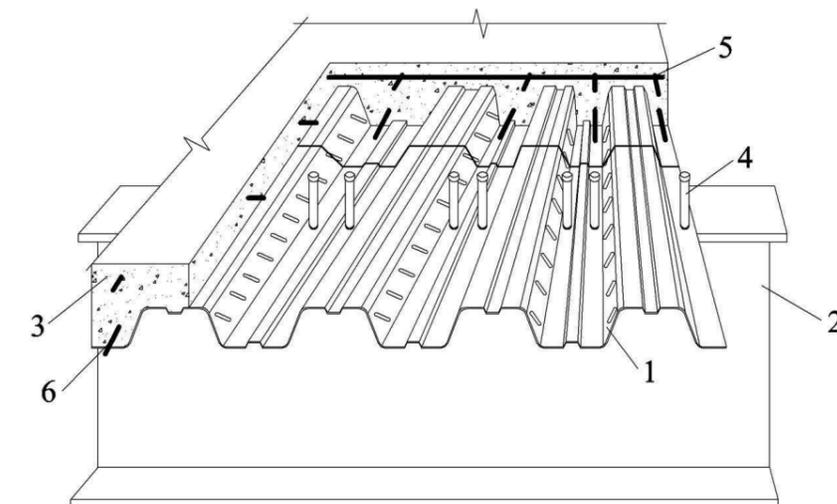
Конструкция сталежелезобетонной плиты, с включенным в работу профилированным настилом: 1 - стальной профилированный настил с рифлеными стенками гофров, 2 – элемент балочной клетки, 3 – монолитный бетон перекрытия, 4 – стержневой анкер, 5 – сетка противоусадочного армирования, 6 – арматура
